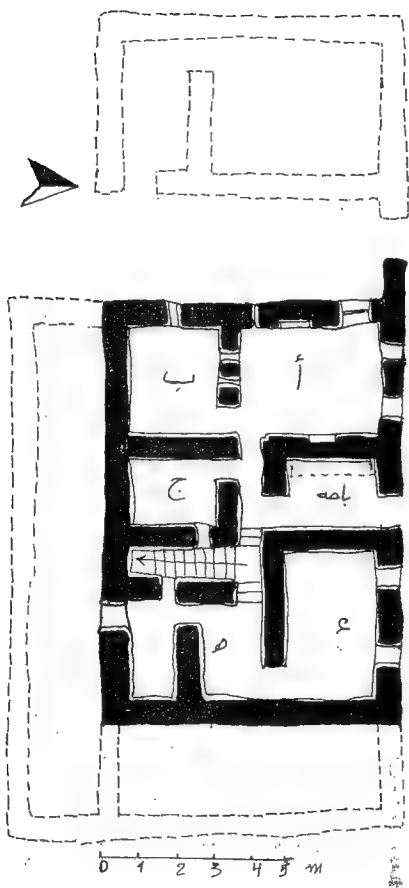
منزل الشريف عبد المطلب الدور الأرضي - مسقط أفقي
